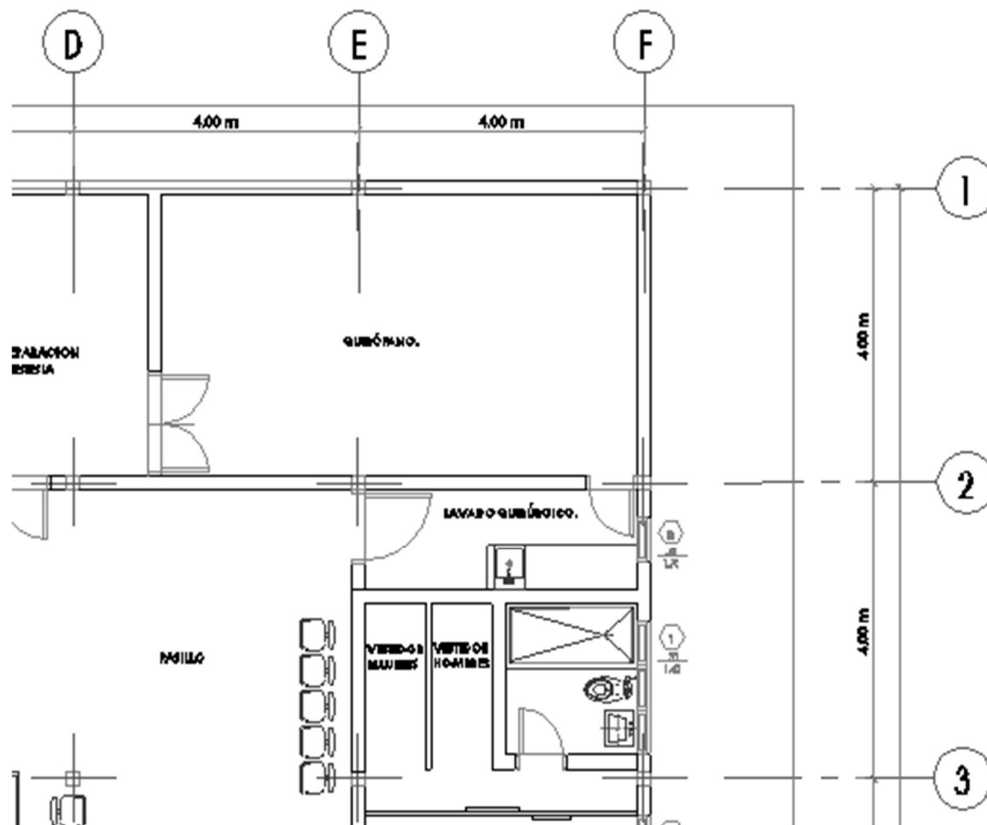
Vista en planta de una sección del segundo nivel de la edificación. Luz de eje a eje 4 m.
